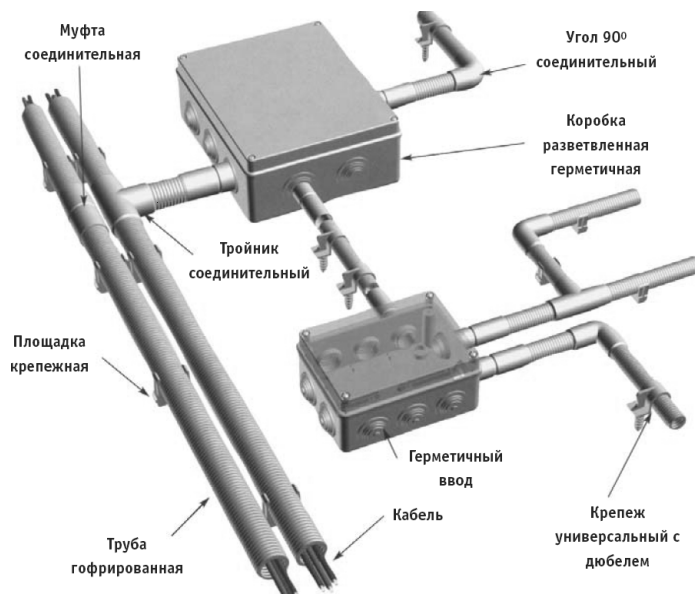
Пример трубной электропроводки в неметаллических трубах
